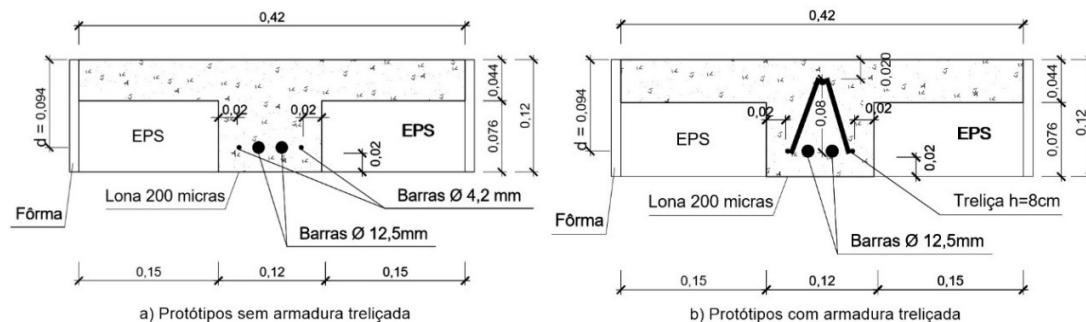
a) Seção transversal das lajes sem armadura treliçada; b) seção transversal das lajes com armadura treliçada
